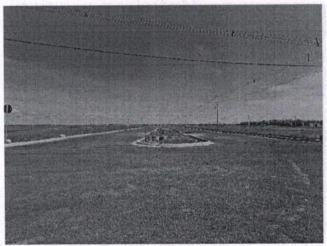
AV. A COM MEIO FIOS NAS LATERAIS E CANTEIRO CENTRAL EXECUTADOS.
